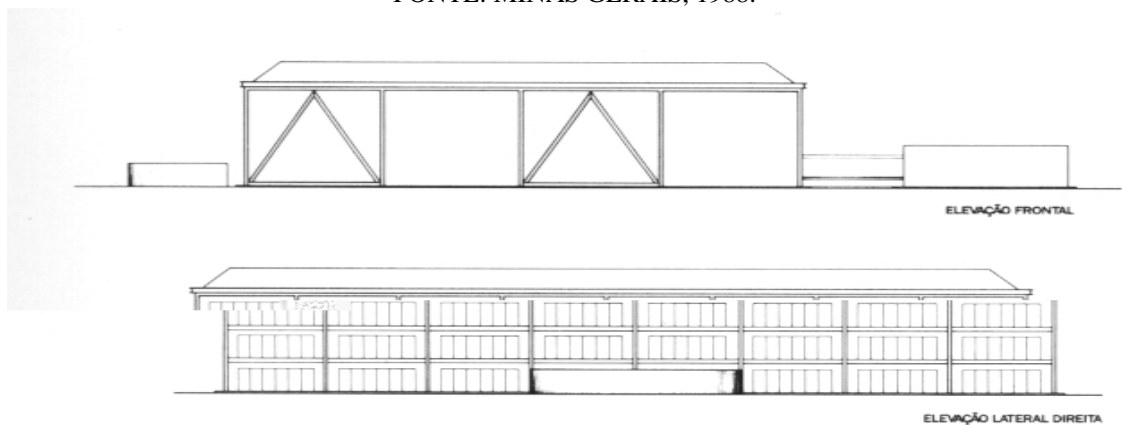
Elevação Frontal e Elevação lateral direita.
